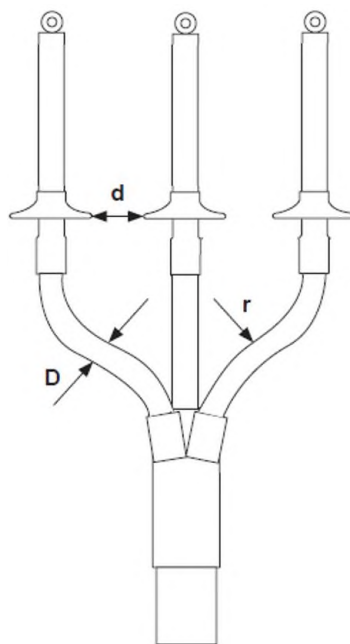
Изгиб кабеля при подсоединении жил к оборудованию.
